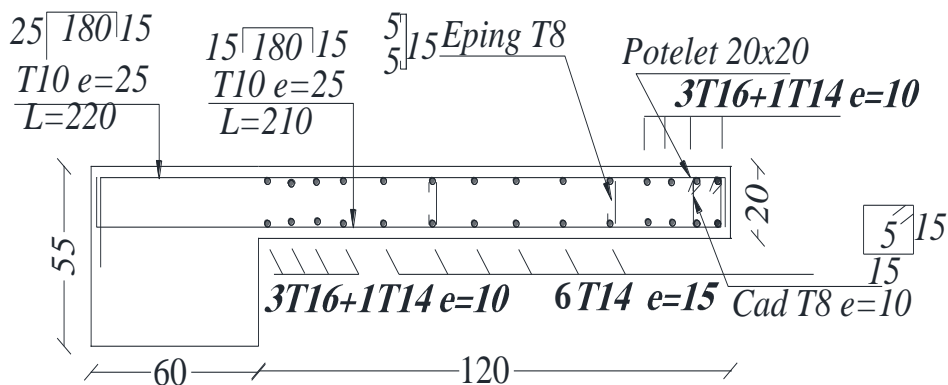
Schéma de ferrailage de voile 9 (L=1,55 m) zone 1.
